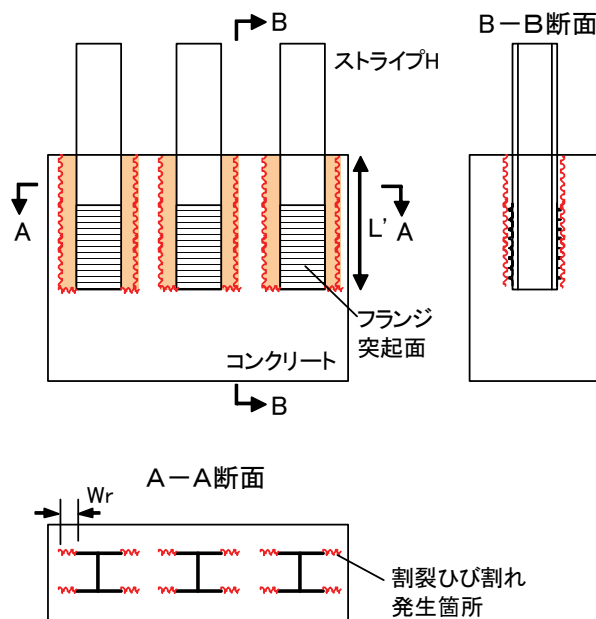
算定式で設定した割裂ひび割れ発生領域の展開図
